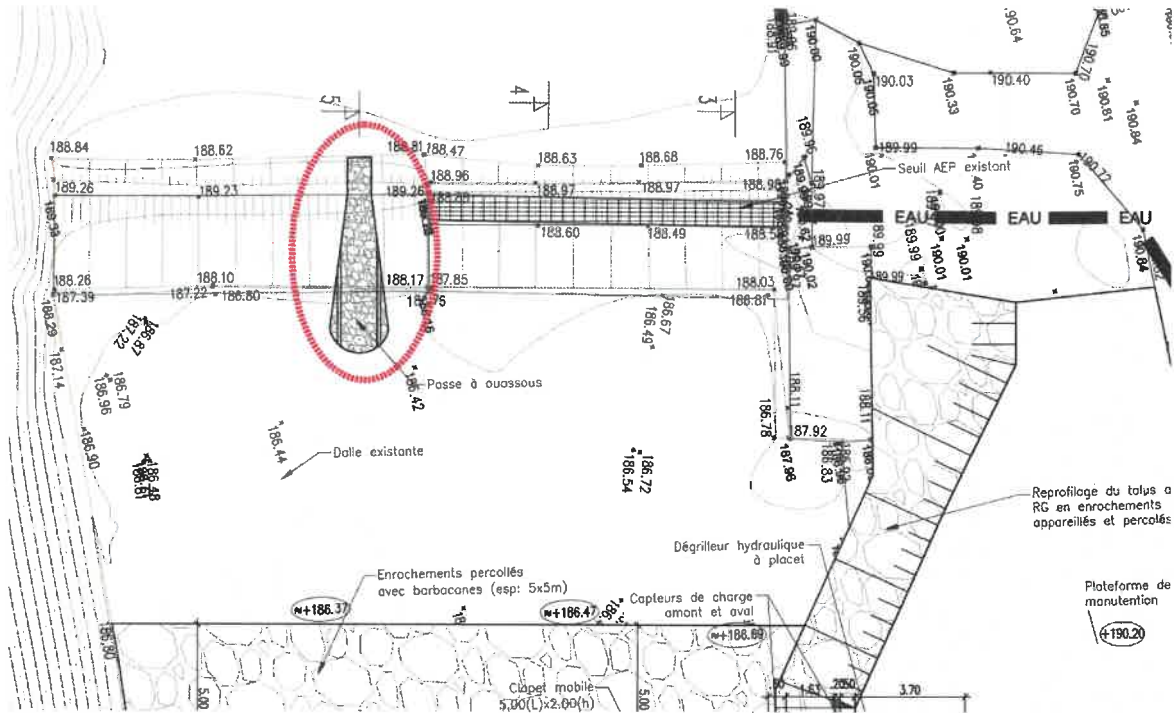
vue en plan de l'implantation de la passe à ouassous sur l'ouvrage existant
